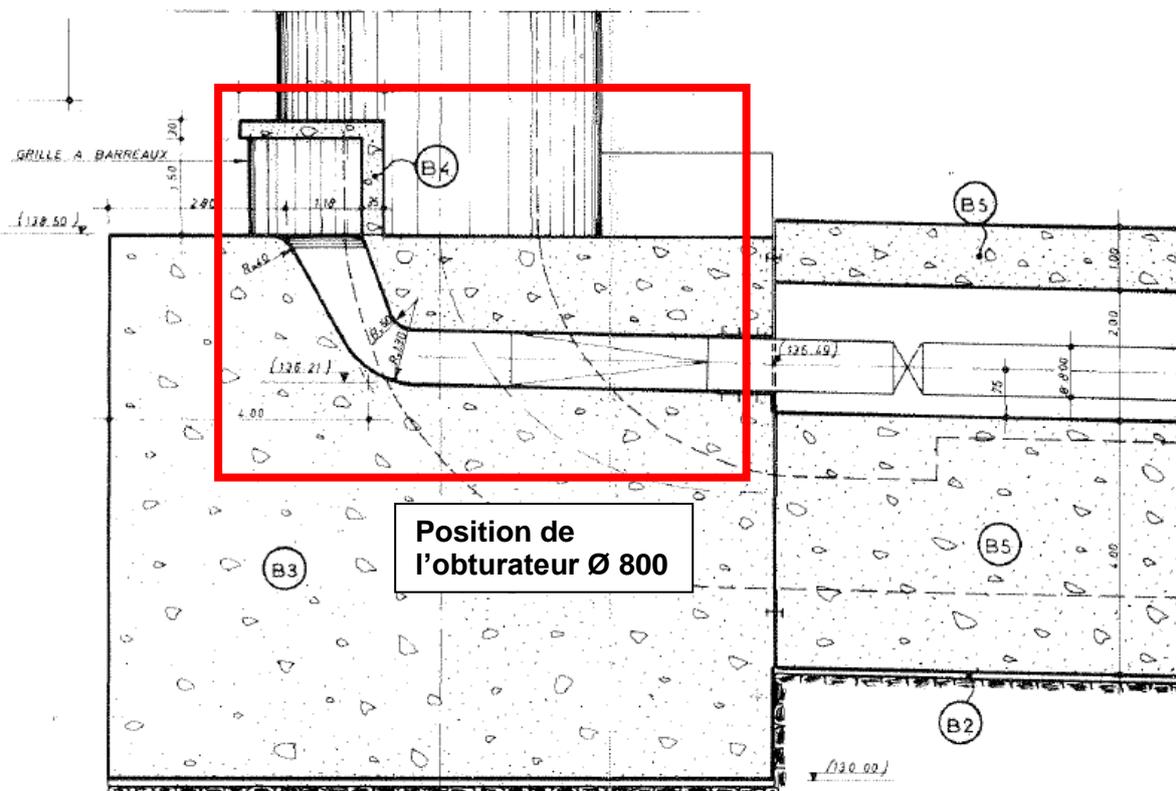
Coupe de l'entonnement en béton de prise et de l'embranchement de départ de la conduite forcée
